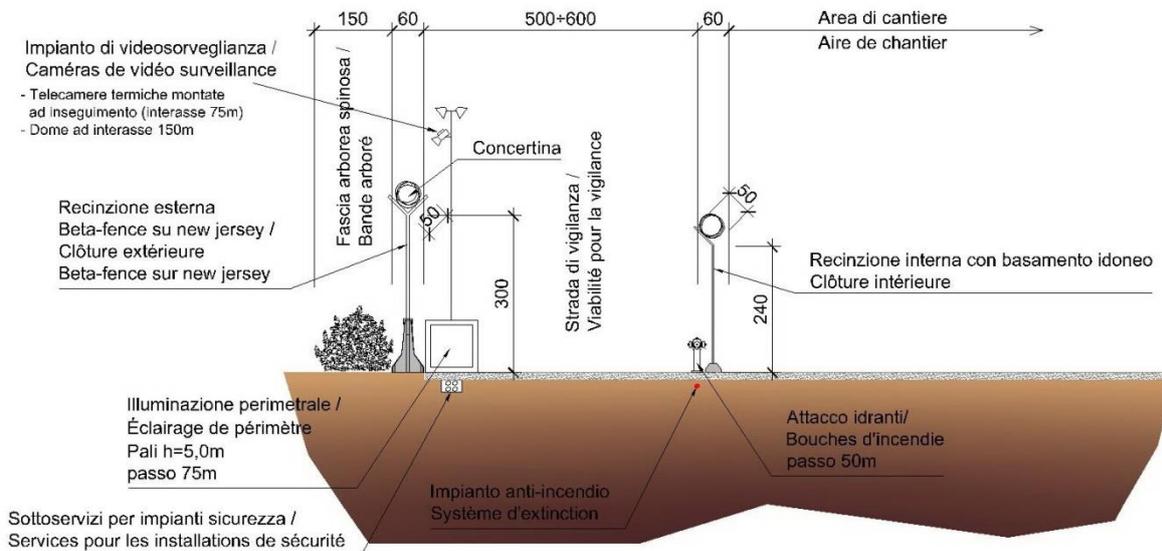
Cantiere Maddalena: sezione tipo viabilità perimetrali
